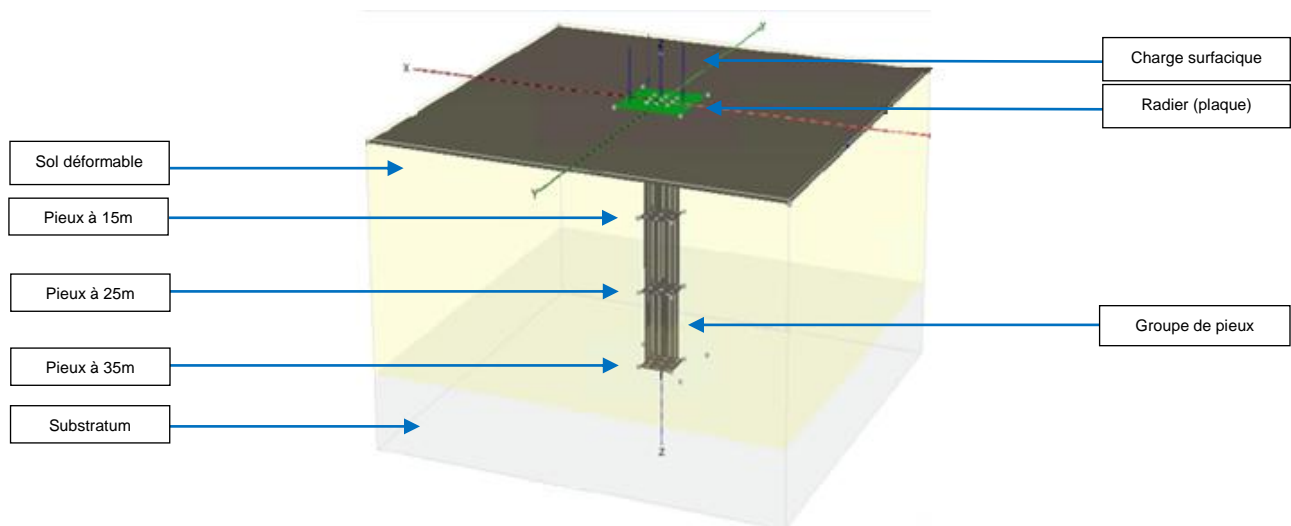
Exemple d'un modèle aux éléments finis 3D d'une fondation mixte
